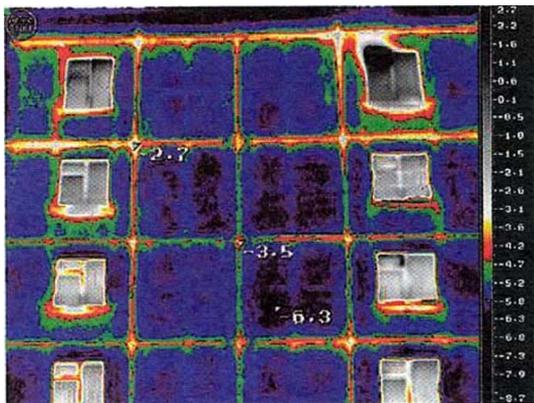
Термограмма стены жилого дома с нарушением теплоизоляции в швах
